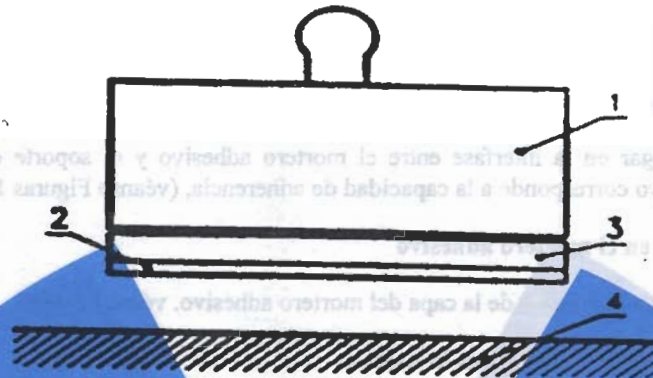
Falla de adhesión entre el mortero adhesivo y el soporte
